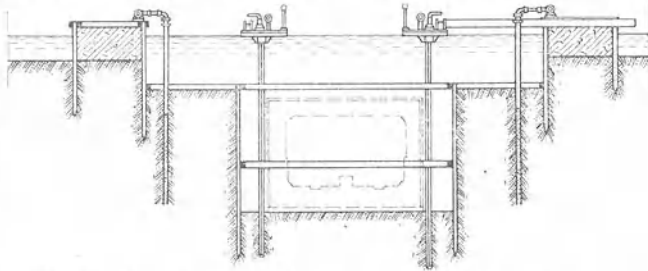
Grundwassersenkungsanlage mit Mammutpumpen.
